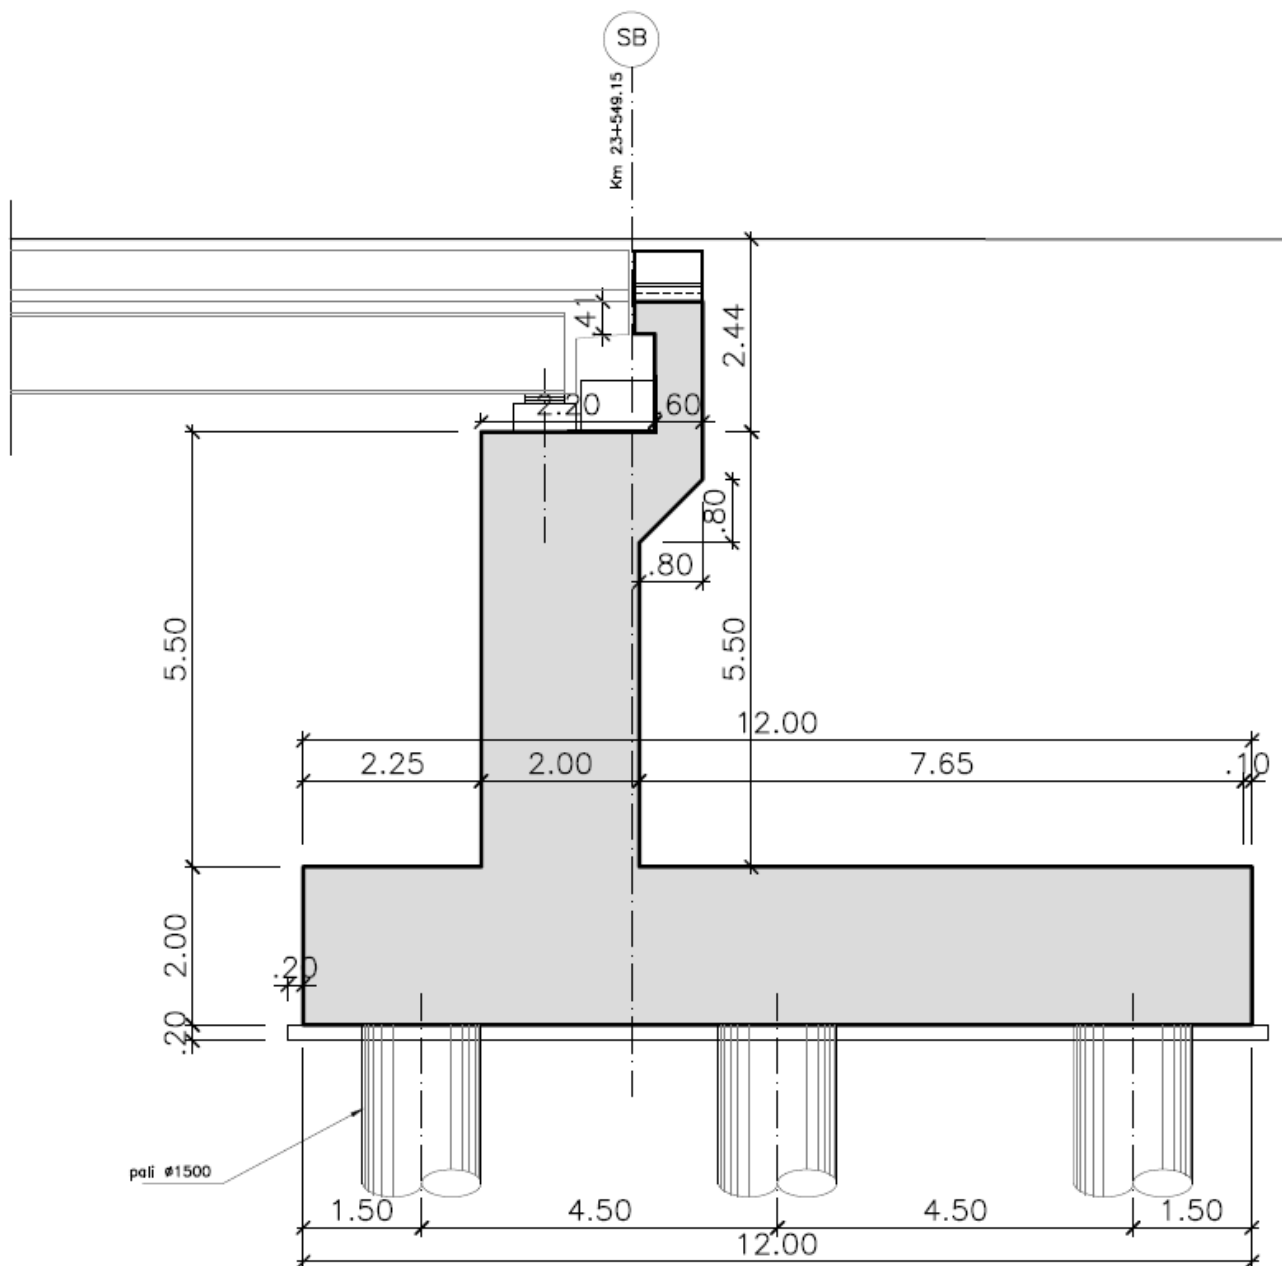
Sezione longitudinale Spalla “B”.
